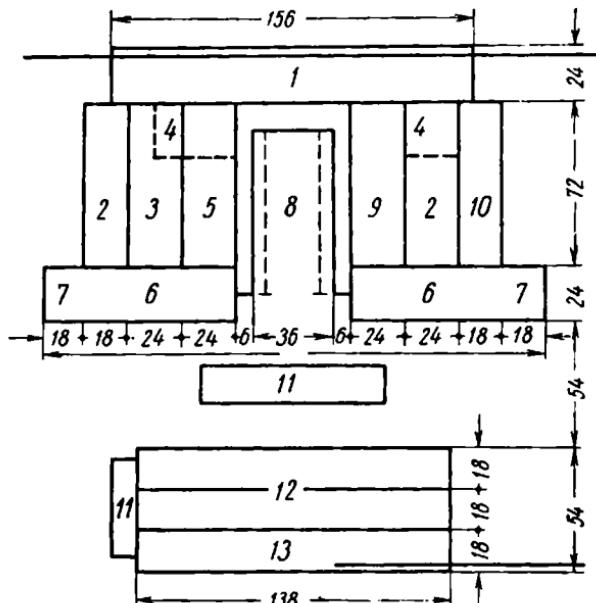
Компоновочная схема чугунолитейного корпуса станколита (проект):
